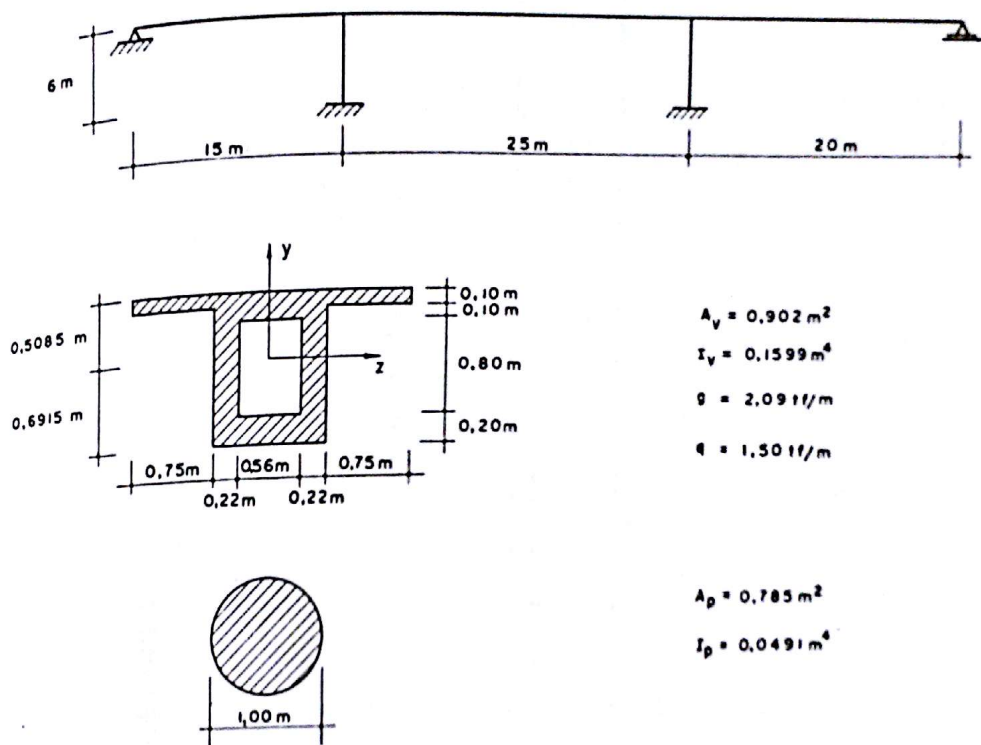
ESQUEMA DA ESTRUTURA E CARACTERÍSTICAS DAS SEÇÕES
